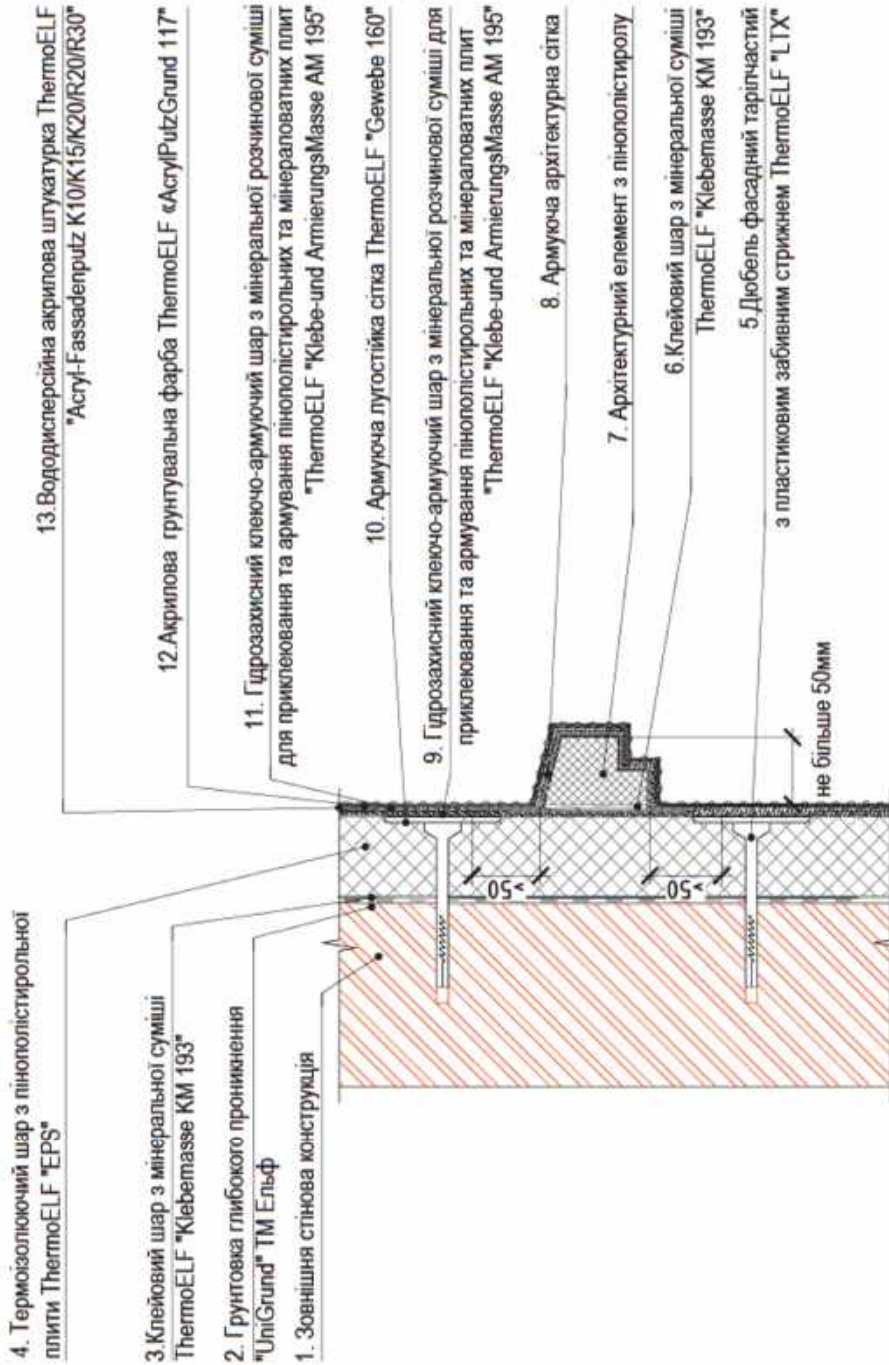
Вузол 3. Влаштування теплової ізоляції архітектурних елементів фасаду будівлі
